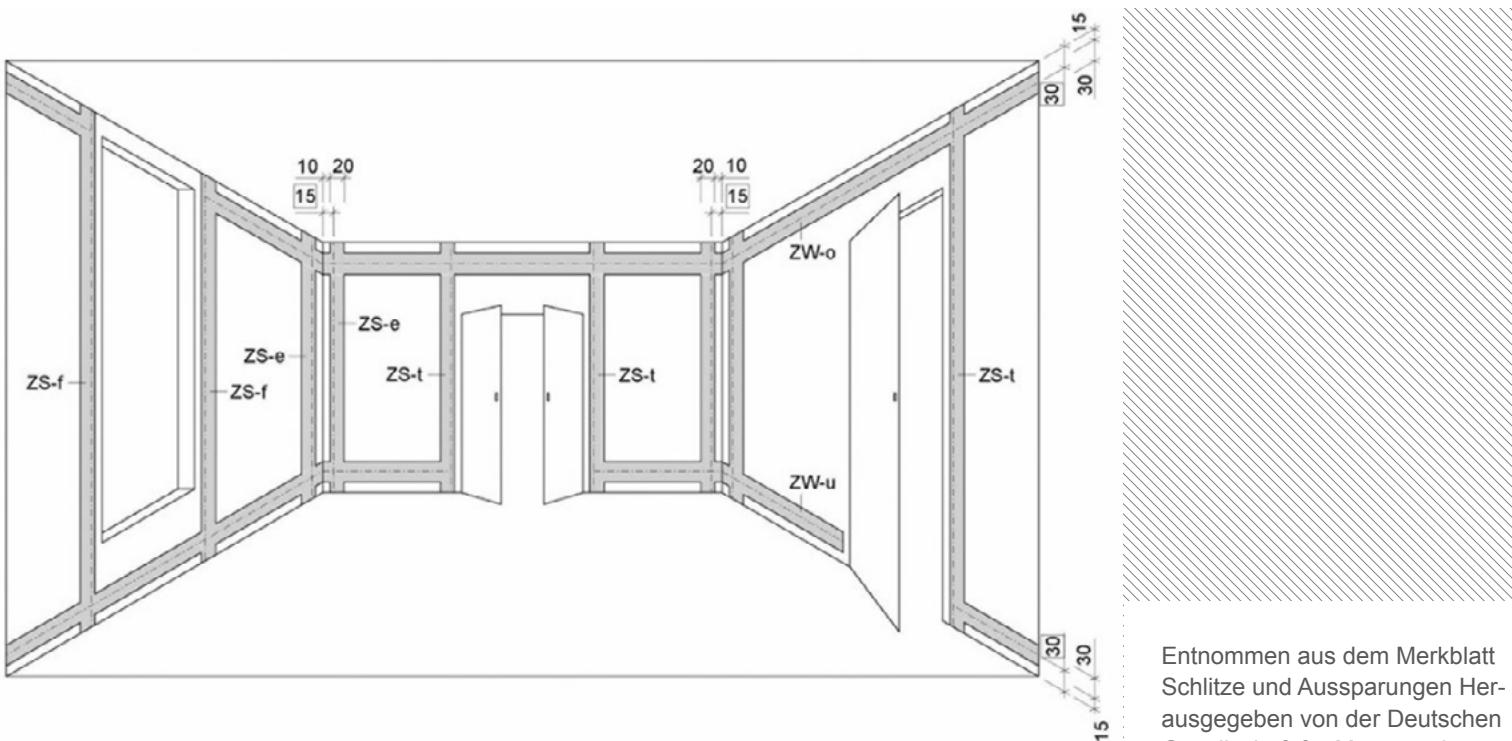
Installationszonen und Vorzugsmaße (im Kasten) für Elektroinstallationen in Räumen (DIN 18015-3). Gilt nicht für Räume mit Arbeitsflächen an Wänden z.B. Küchen.
